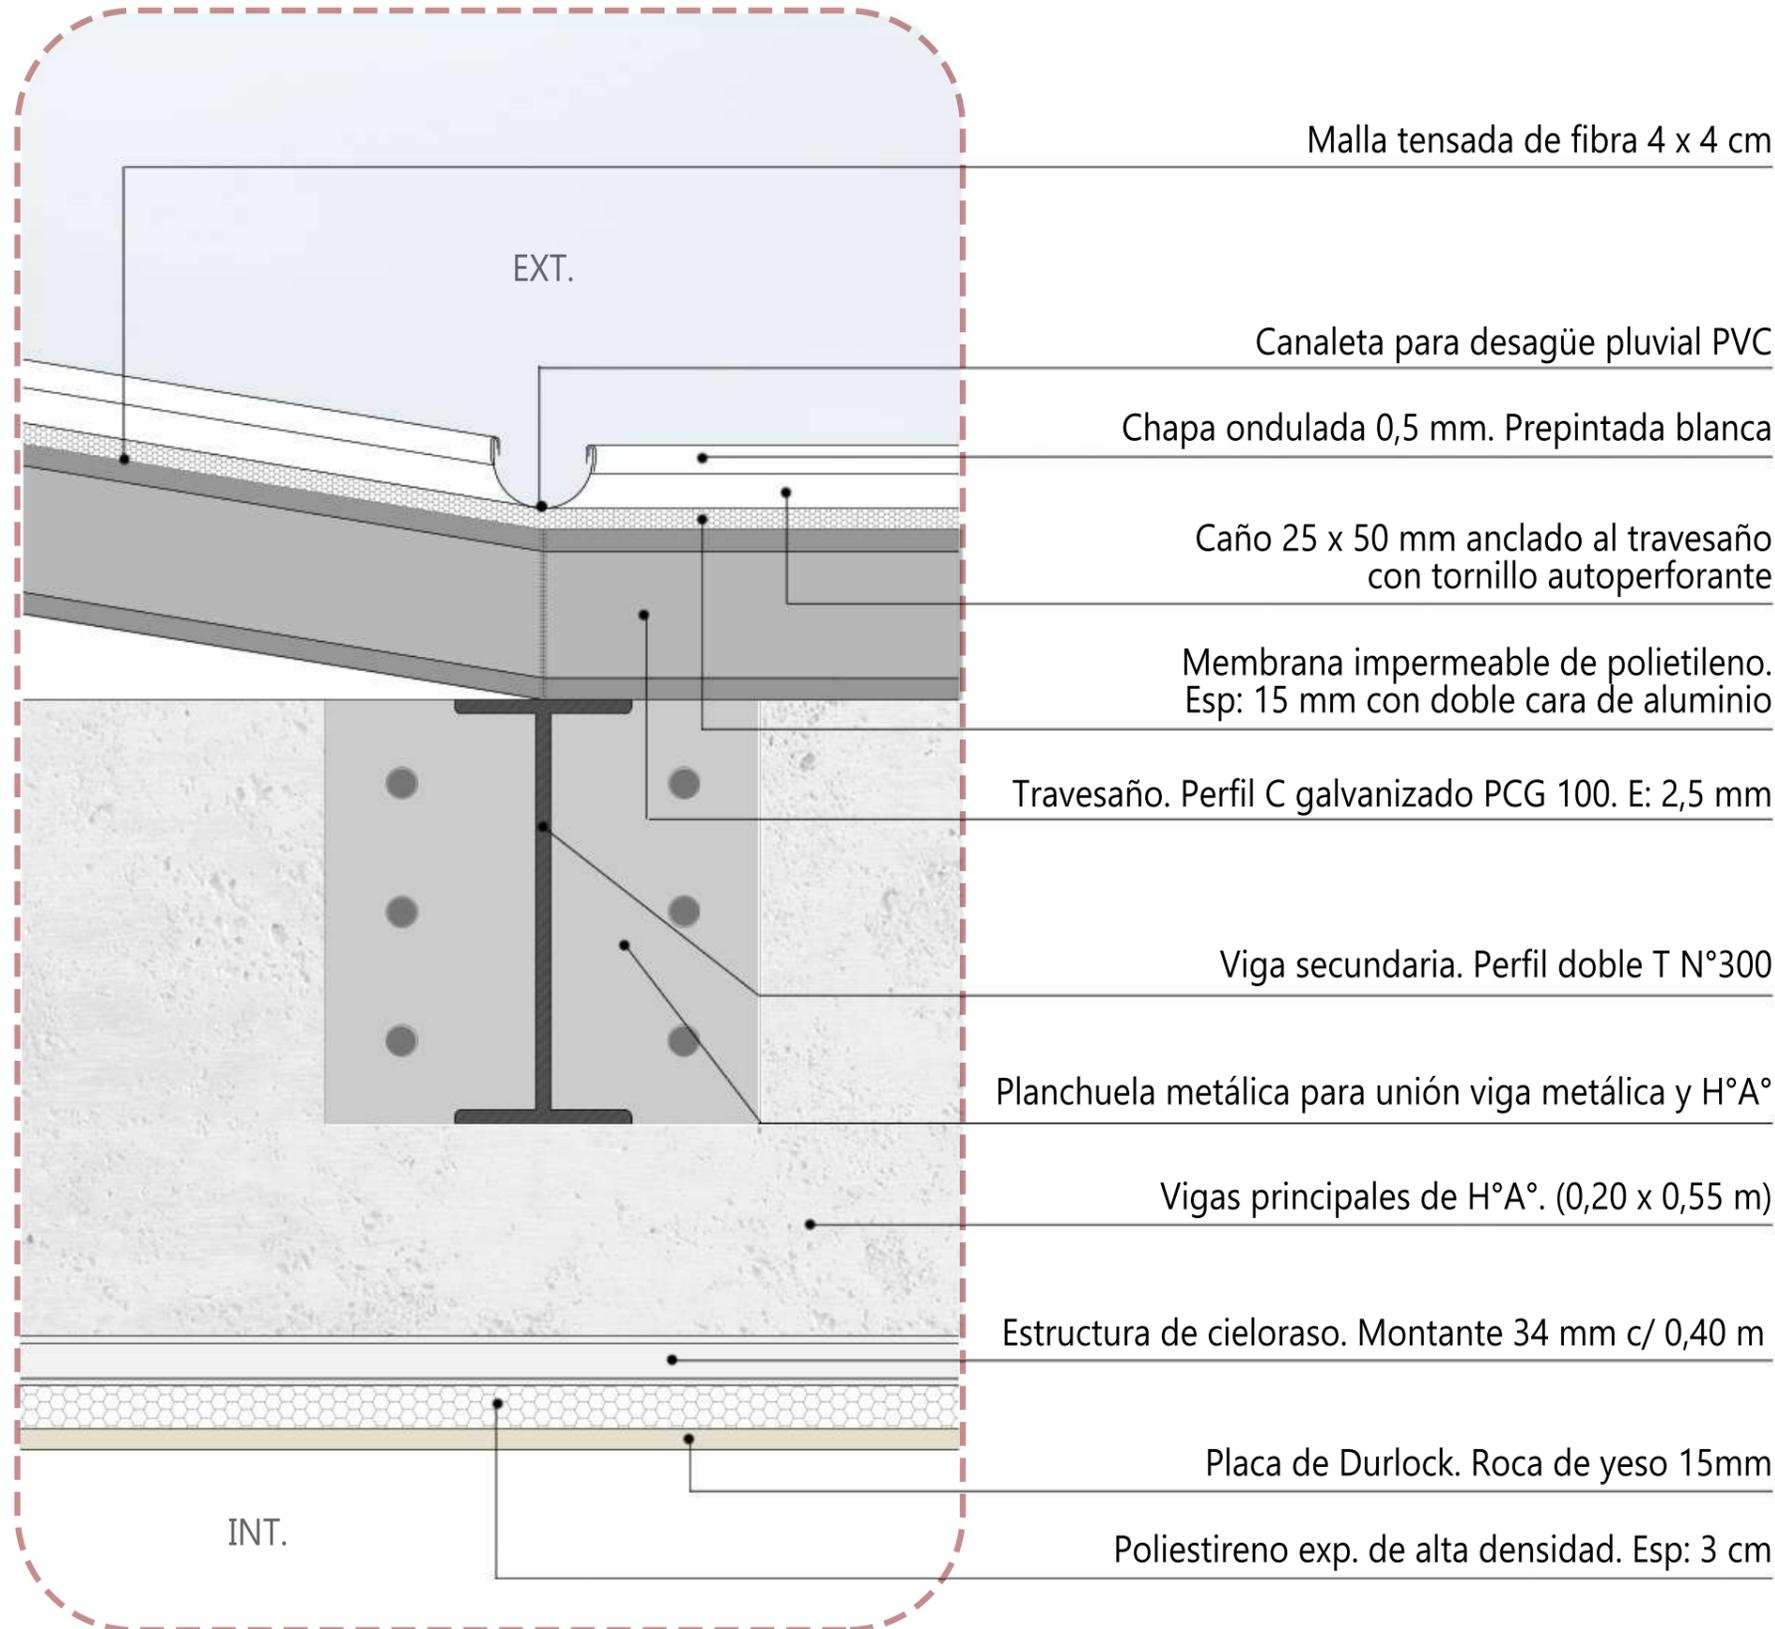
IMAGEN REFERENCIA. Fijación de una viga de acero sobre una viga de hormigón
